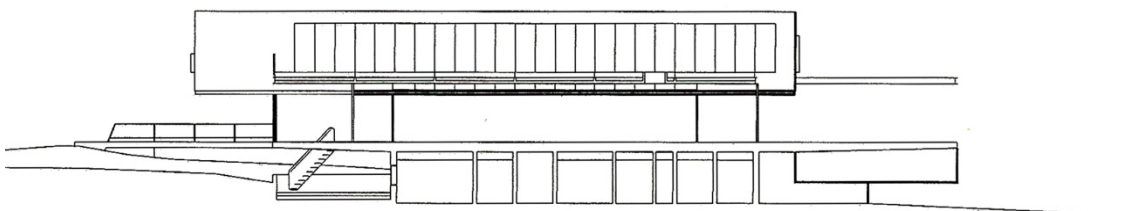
Sección. 2G Revista Internacional de Arquitectura
